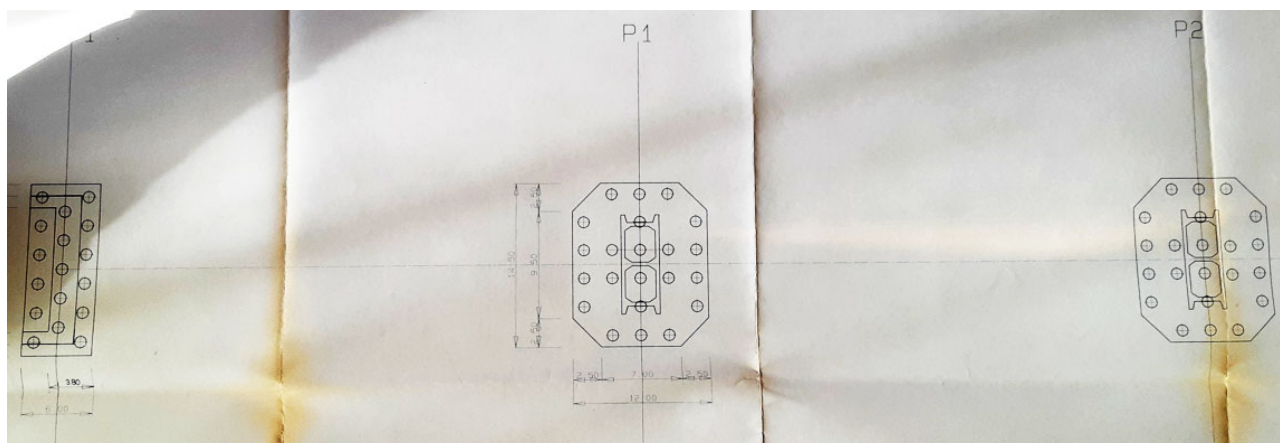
Stralcio pianta fondazioni (SP1-P1-P2)
